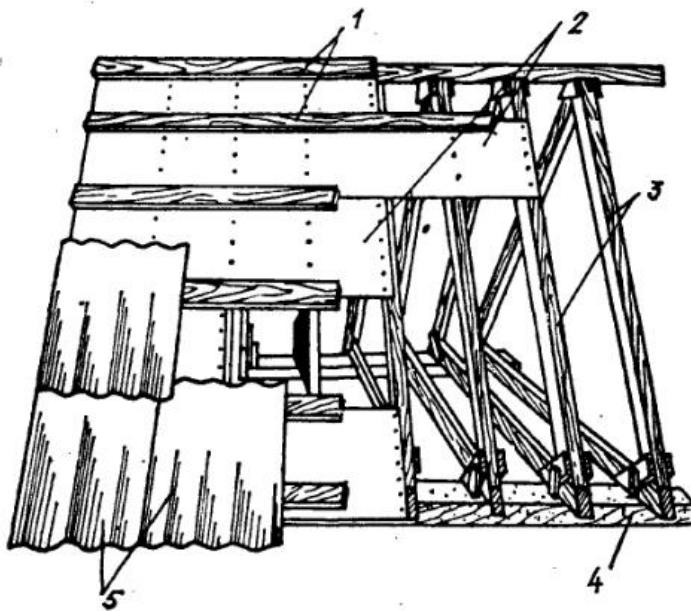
Конструктивное решение крыши: 1 — обрешетка; 2 — настил; 3 — стропила; 4 — мауэрлат; 5 — шифер.
